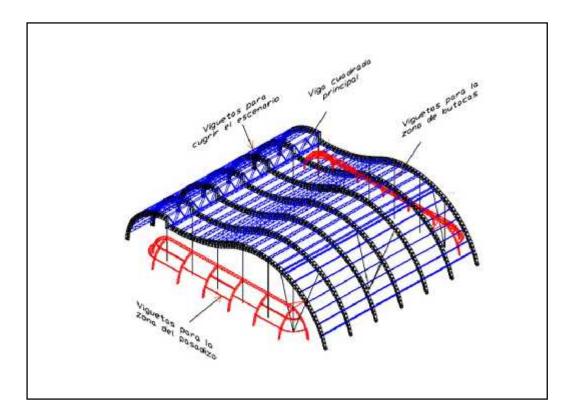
Ubicación de los diferentes tipos de vigas en la estructura.
